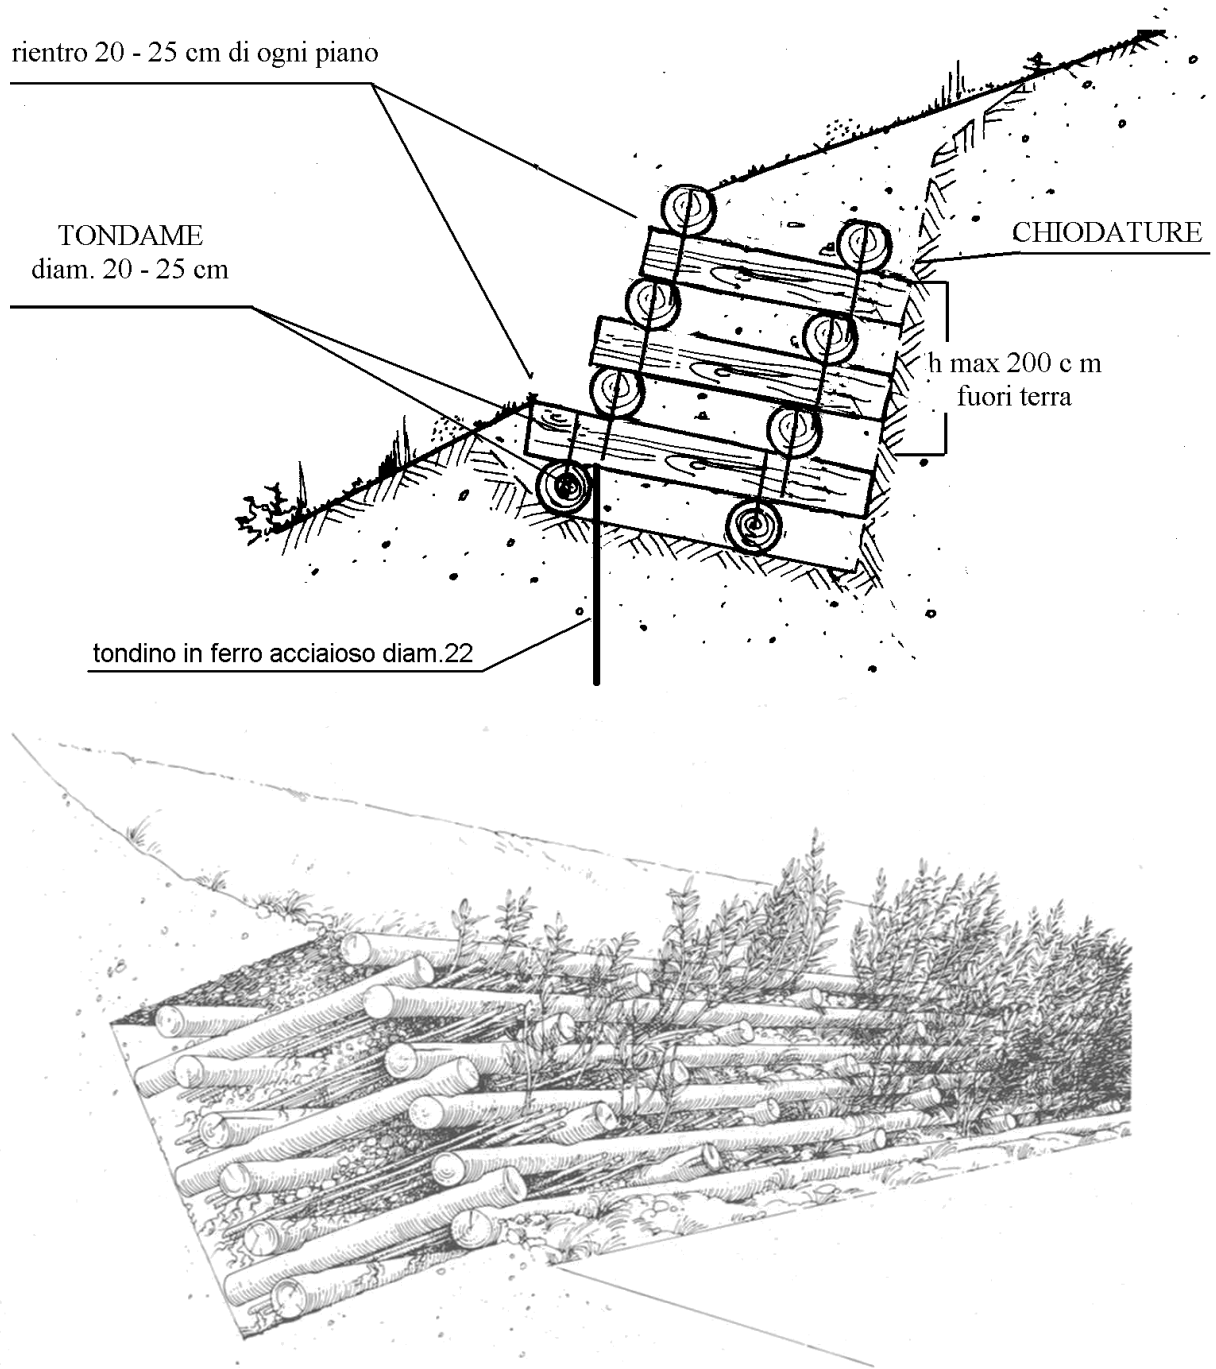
Palificata viva di sostegno a parete doppia - sezione e vista prospettica.
